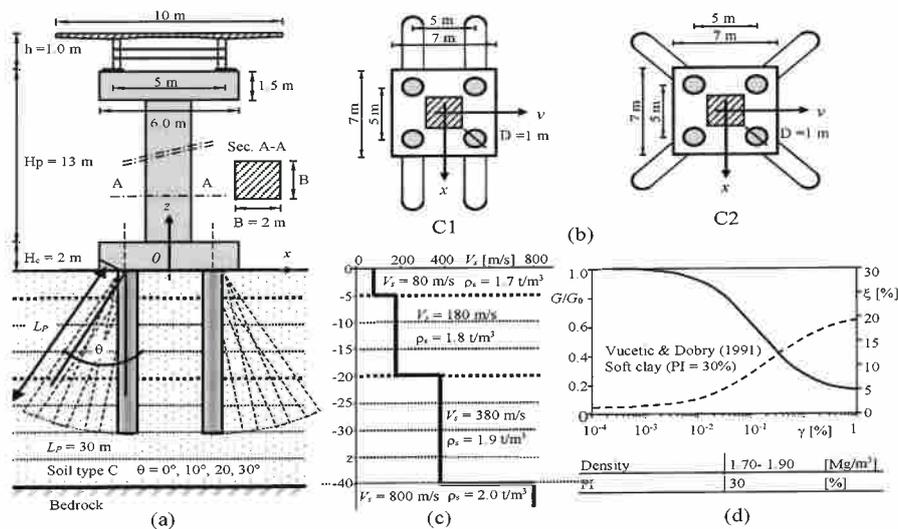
(a) Sezione trasversale del sistema sovrastruttura-fondazione-terreno; (b) Geometria fondazioni; (c) velocità delle onde di taglio e profilo del deposito considerato e (d) curve di decadimento e smorzamento del terreno
